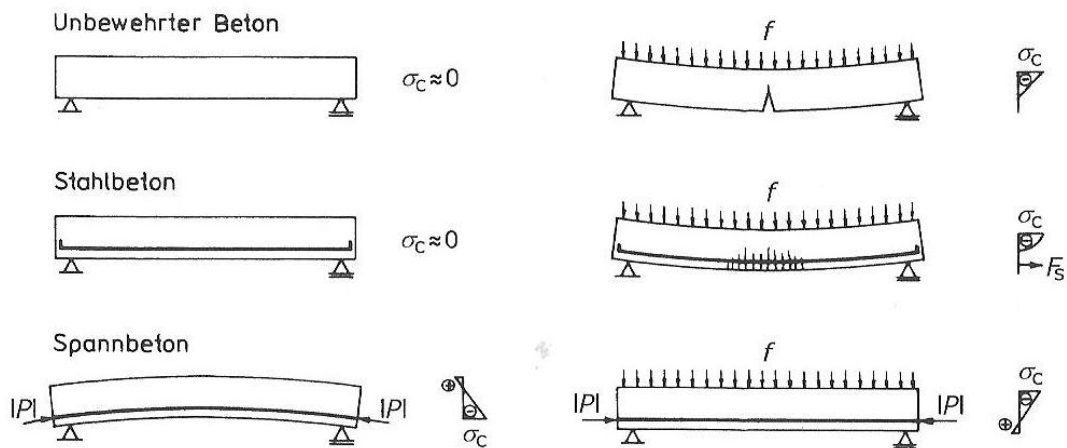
Gegenüberstellung von Spannbeton, Stahlbeton und unbewehrter Beton [3]
